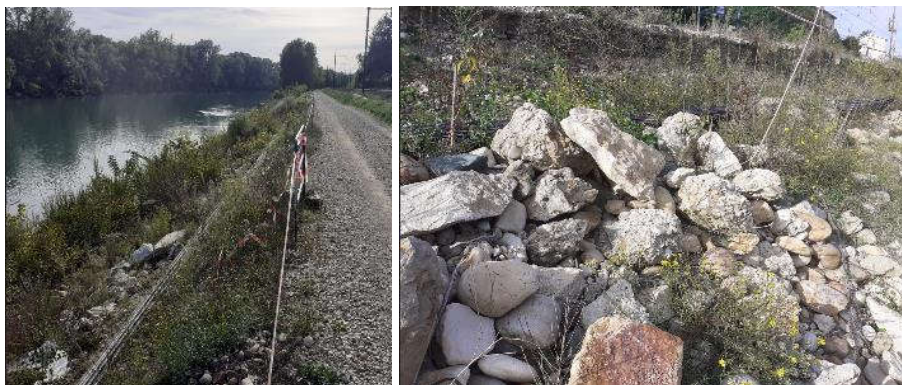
visite sur site 09/2023 et 11/2023 ; source : setec hydratec
